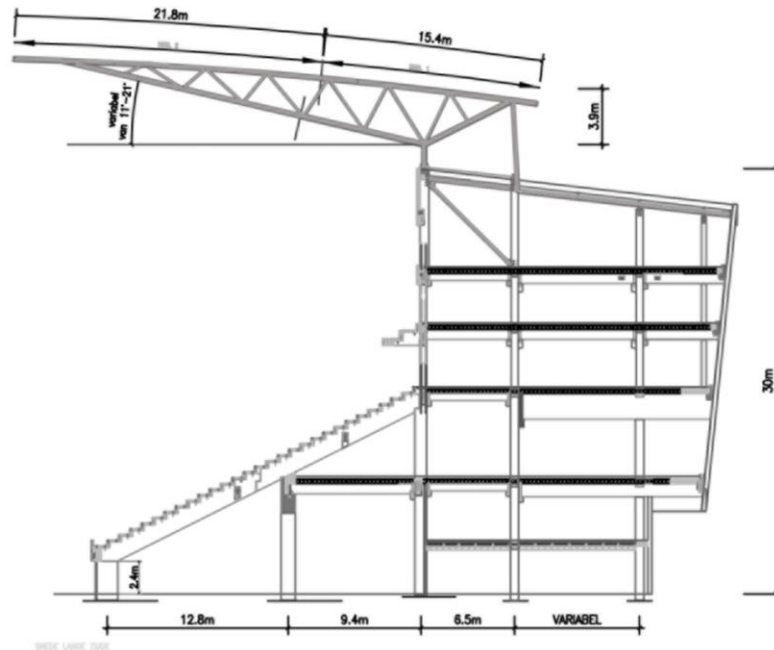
Coupe structurelle (Vk Engineering, 2014)
